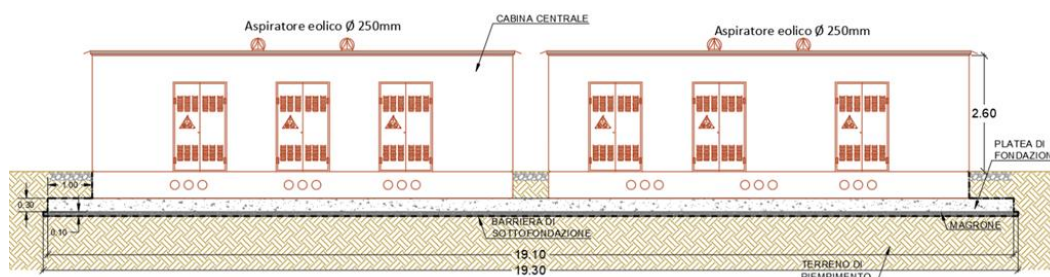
Prospetto frontale con platea di Fondazione della Cabina di Centrale
